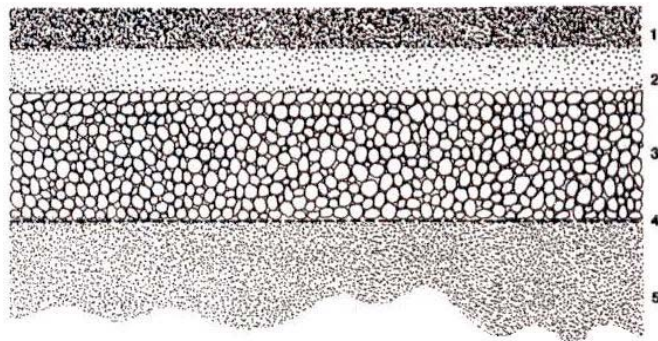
Elementos de un pavimento poroso: 1.- Carpeta de rodado de asfalto poroso, 2.- Base o filtro granular graduado, 3.- Subbase de grava, uniformemente graduada, 4.- Filtro geotextil, o filtro granular, o membrana impermeable, 5.- Subrasante de suelo nativo..
